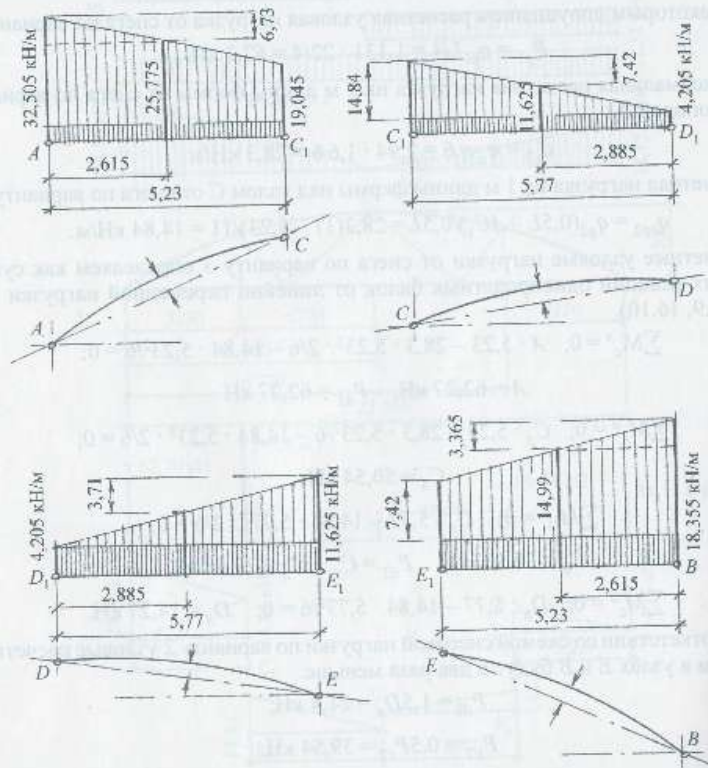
Расчетные схемы и нагрузки отдельных панелей фермы
